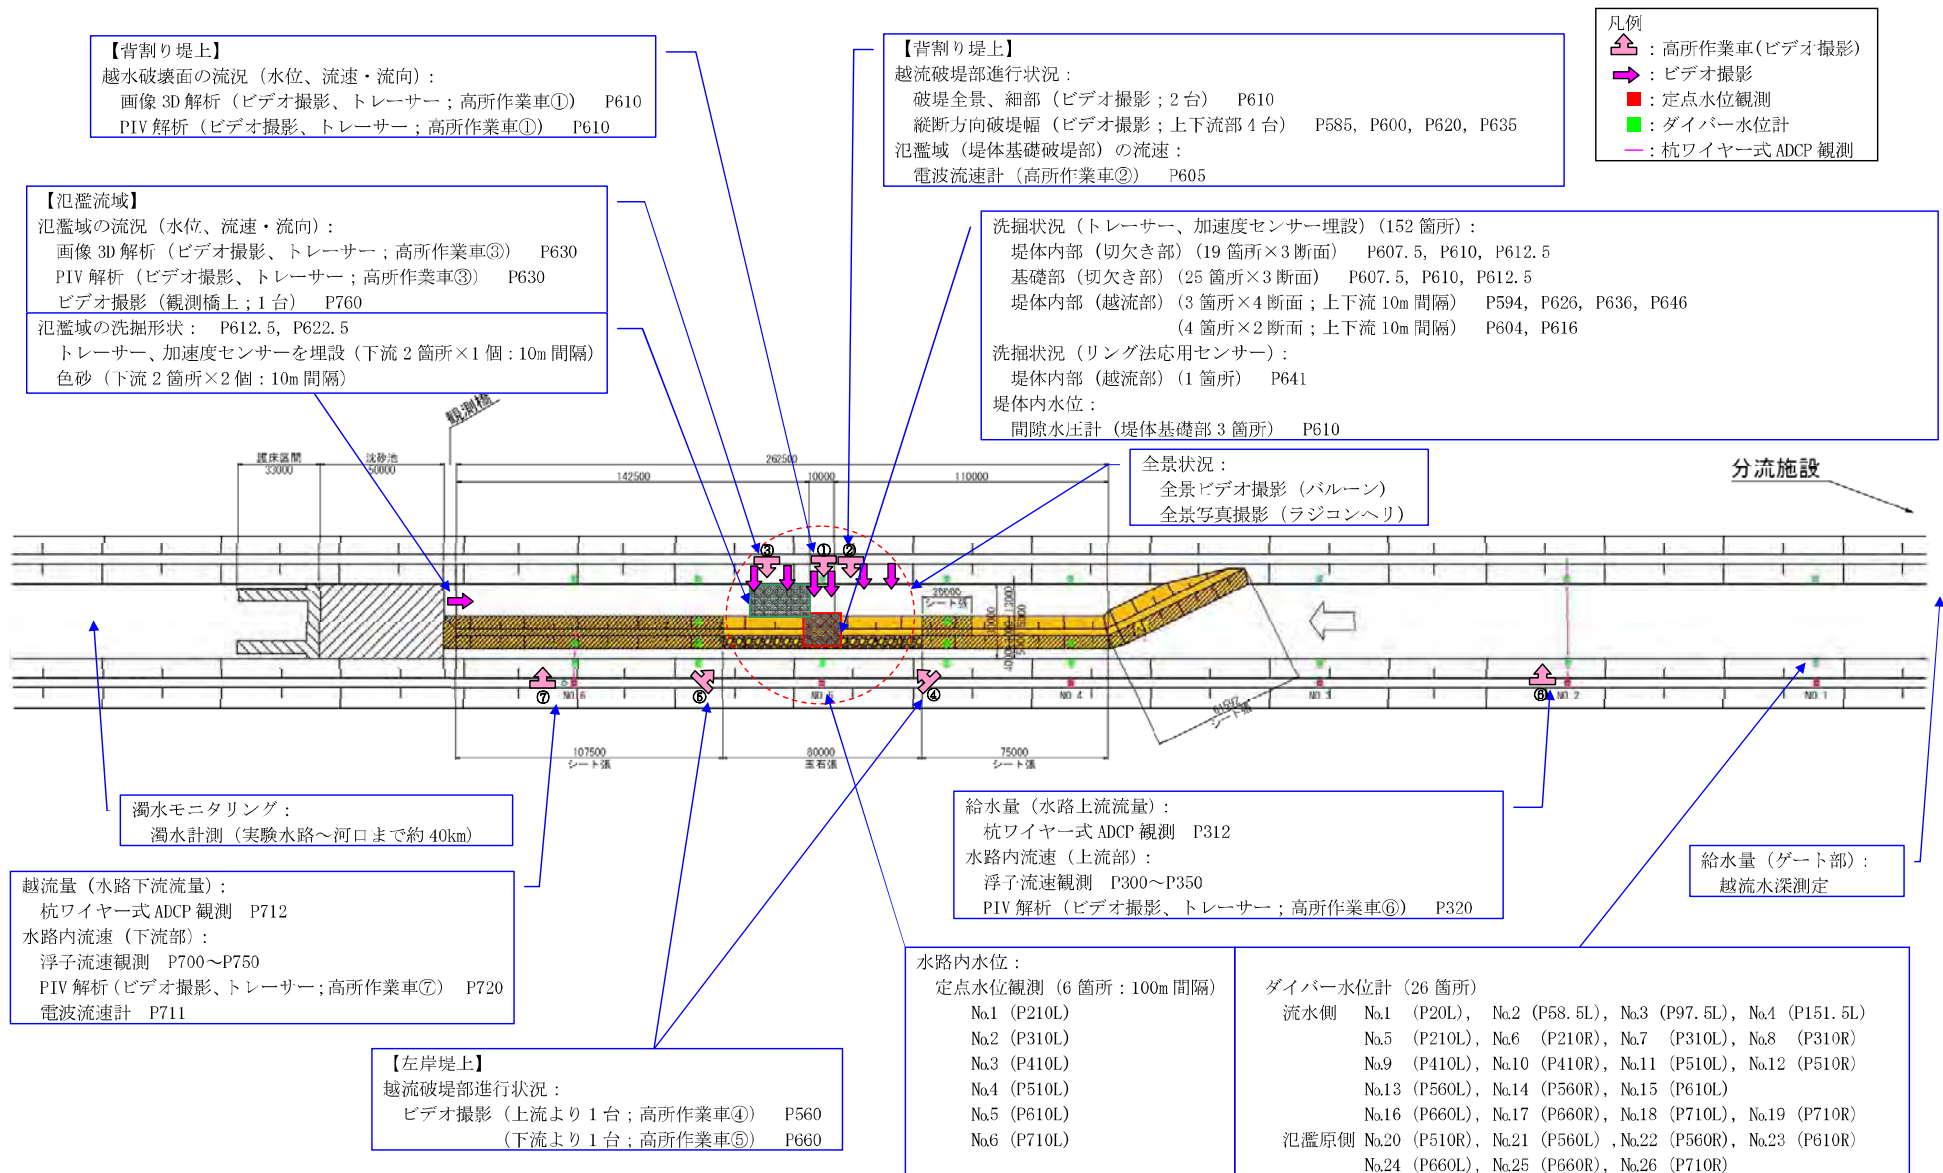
(1) 実験②③（破堤実験）の計測地点配置図
